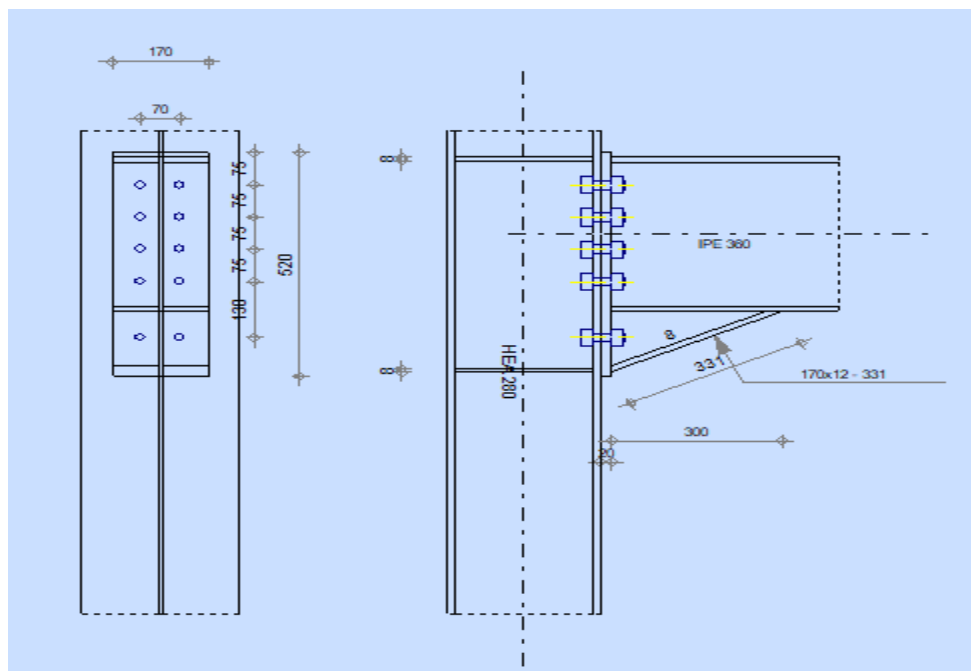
5 : Représentation de l'assemblage poteau – poutre
